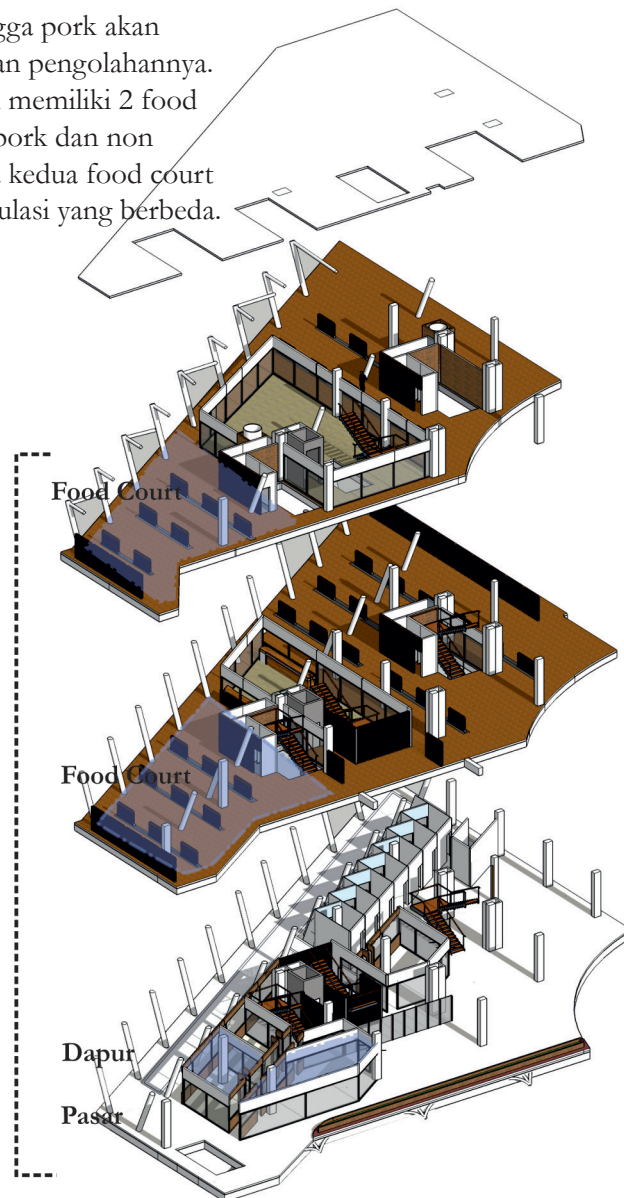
Sirkulasi Pengunjung Lantai 1
